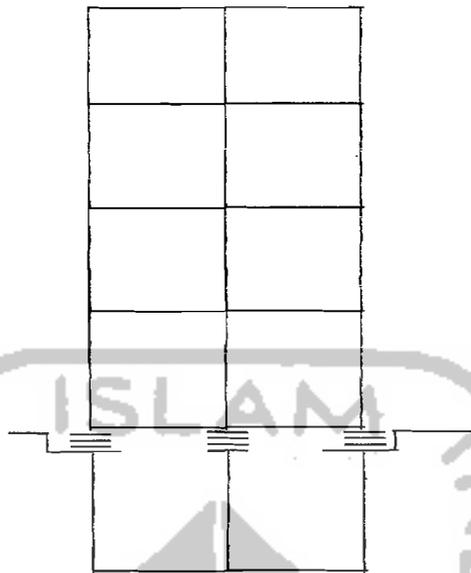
Isolasi dasar ditempatkan pada dasar kolom lantai pertama (*first story columns*)
